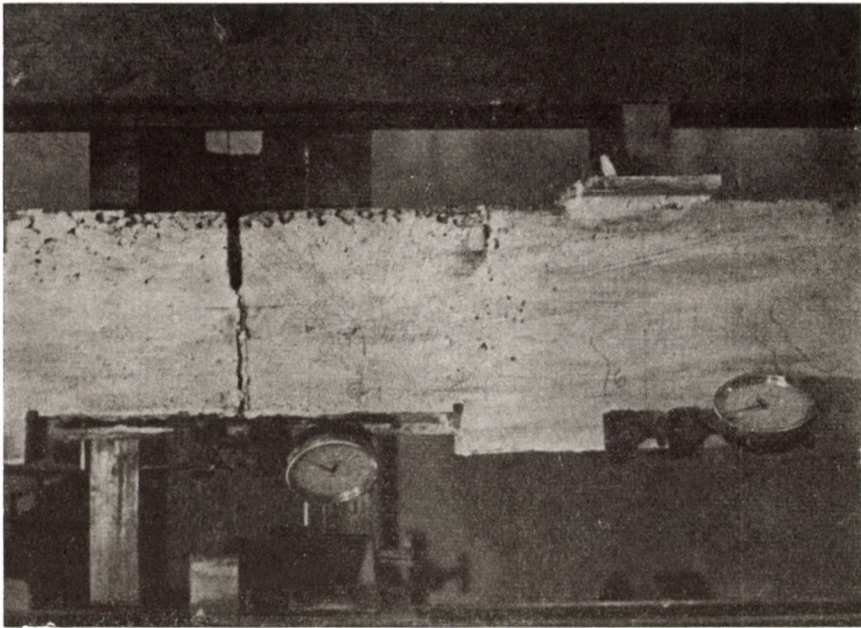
Versuchsanordnung. Balken mit künstlichem Riß und nicht einbetonierter Zugbewehrung
